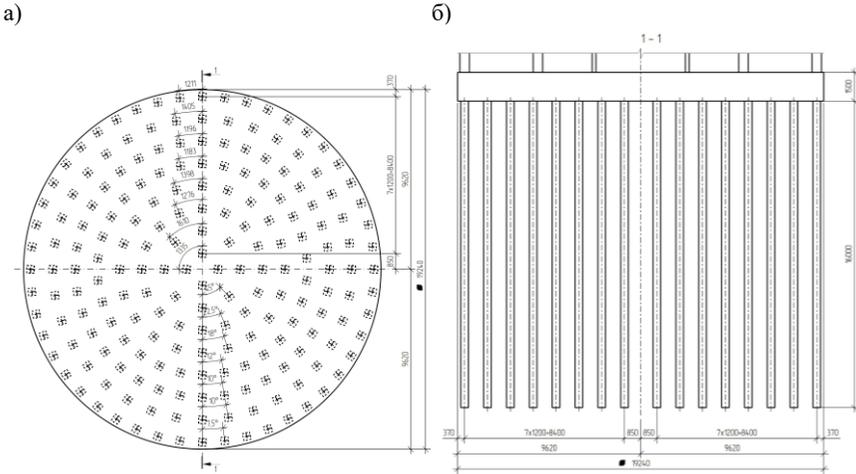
Фундамент здания с несущим стилом: а) план; б) разрез
